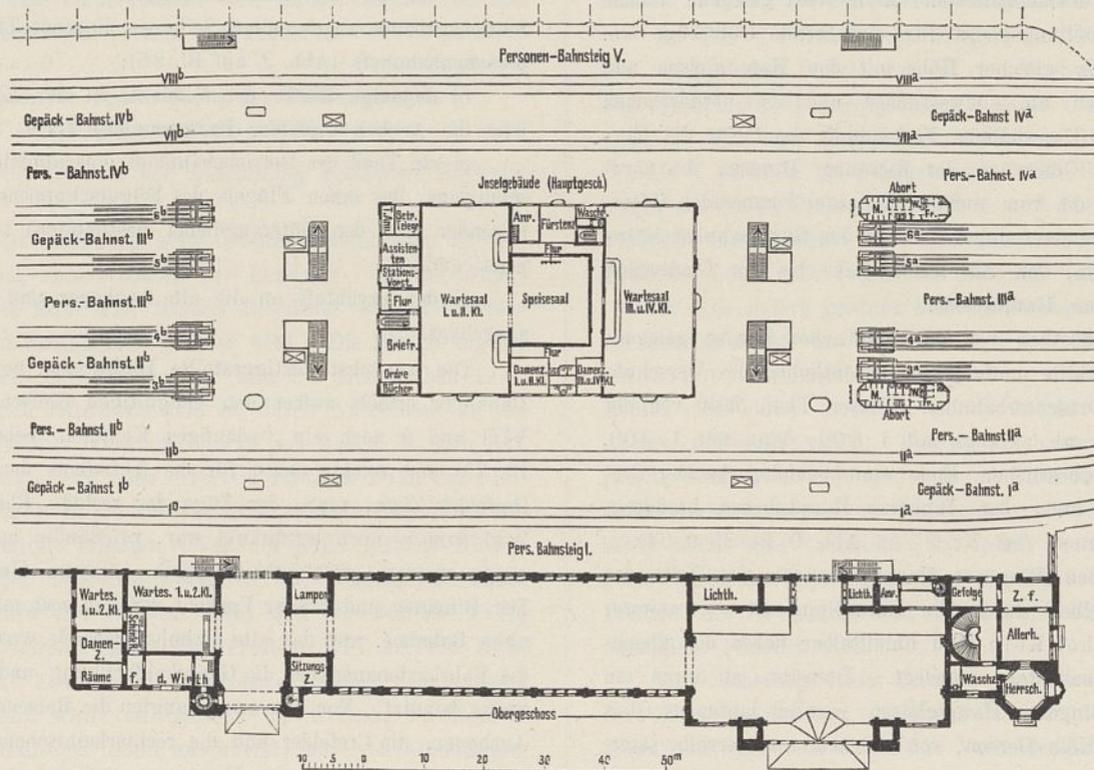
Grundriss in Höhe des Bahnsteigs.
